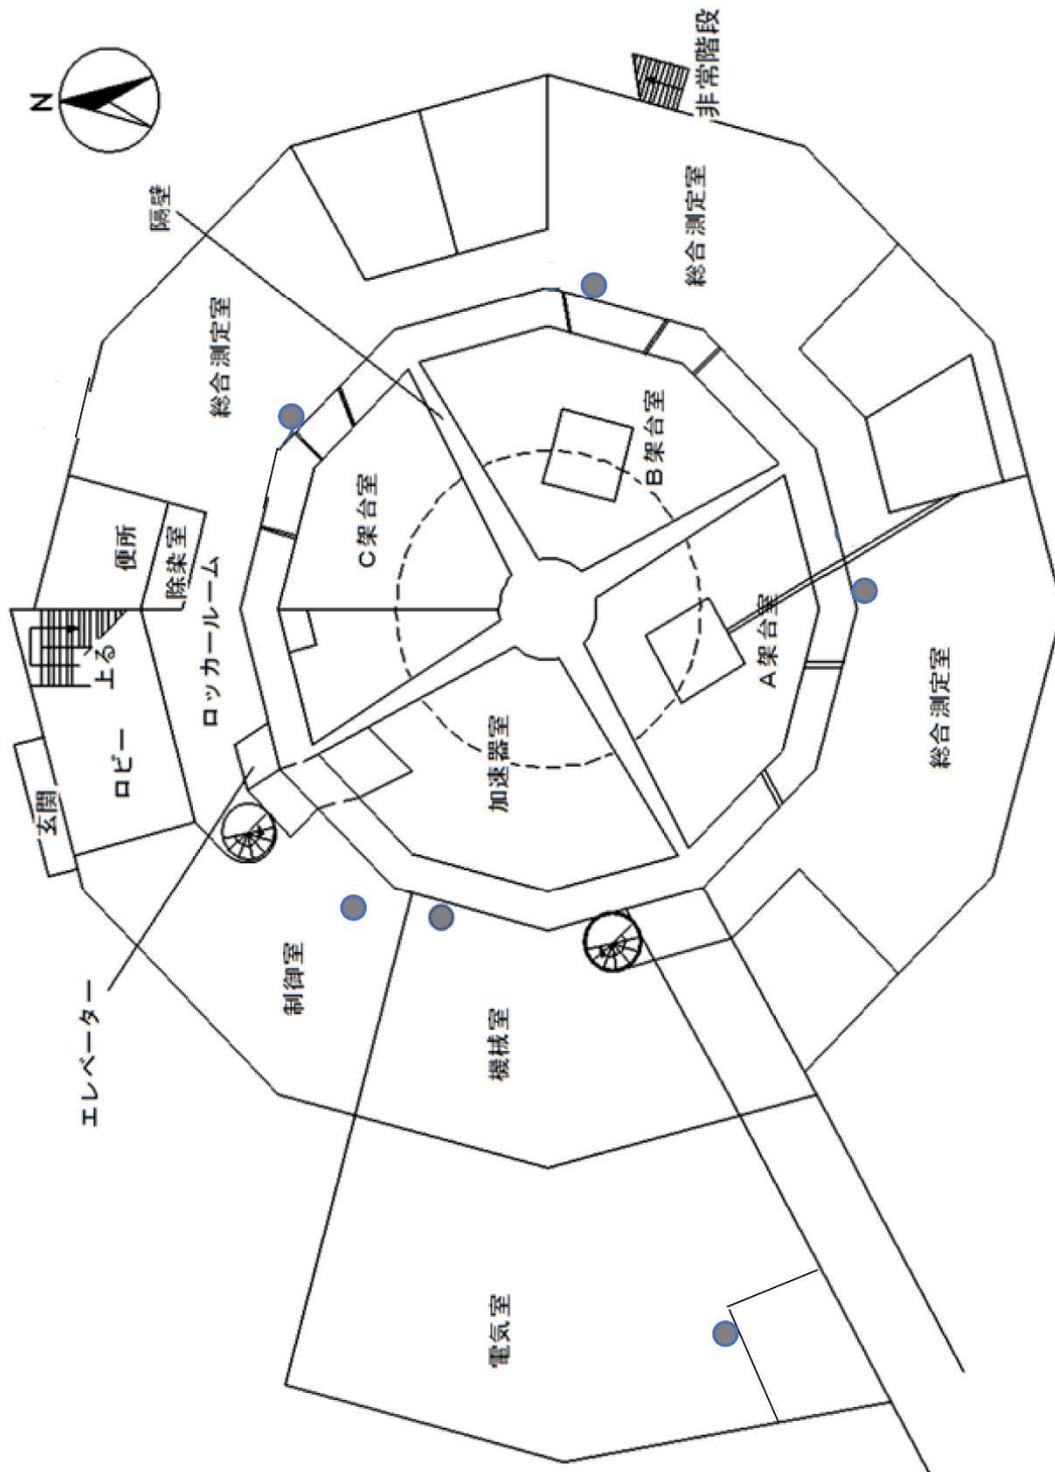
スピーカー配置図 (臨界集集体棟 1 階平面図)
